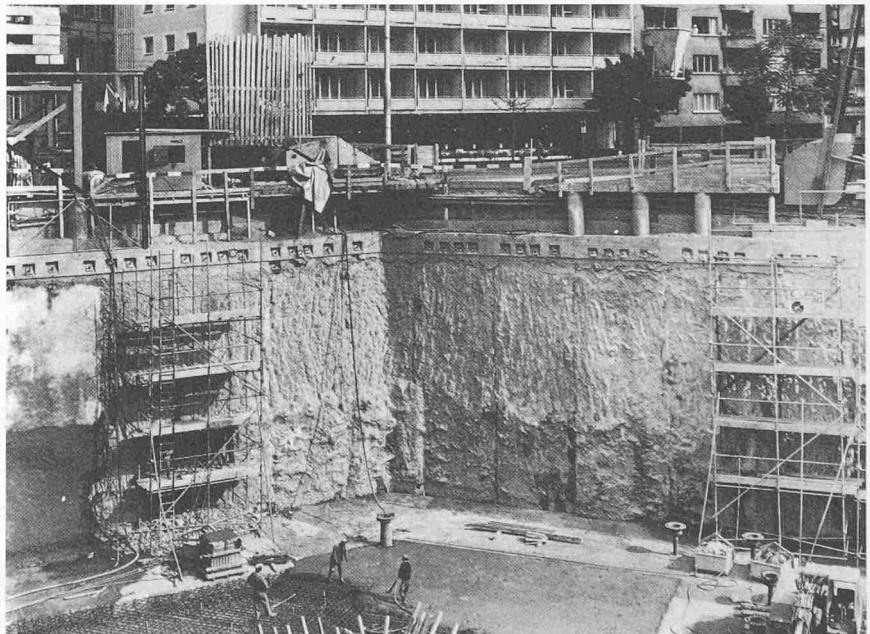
Rentenanstalt Zürich. Vue partielle de l'excavation
